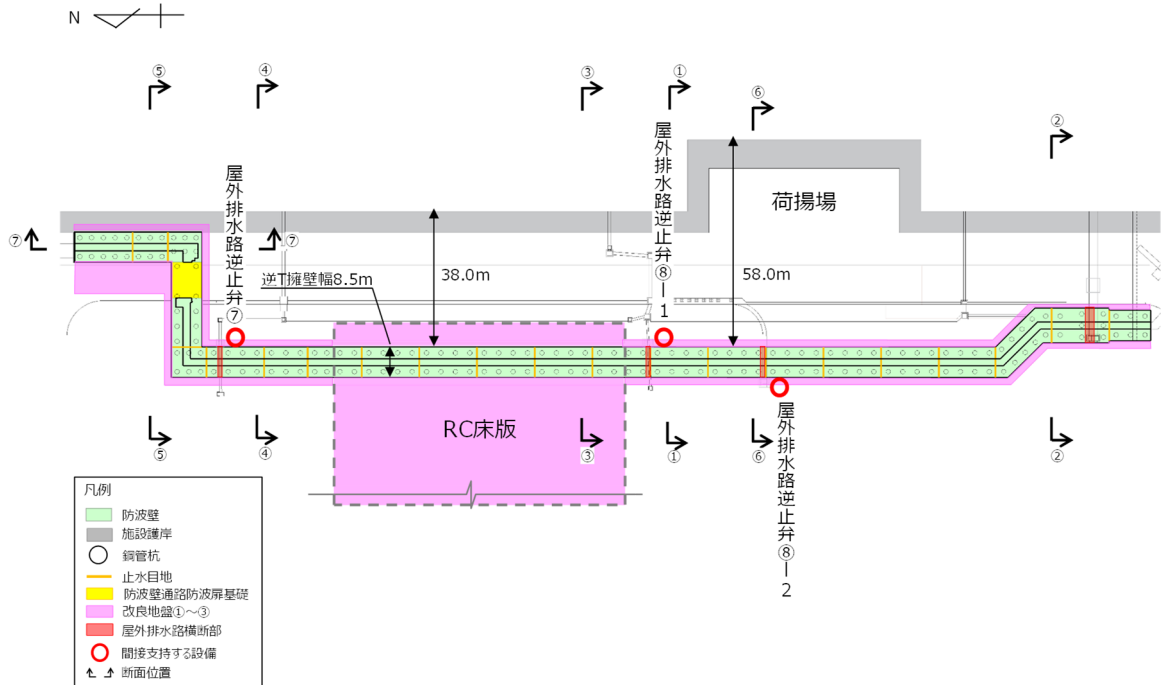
防波壁（逆 T 擁壁）平面配置図
